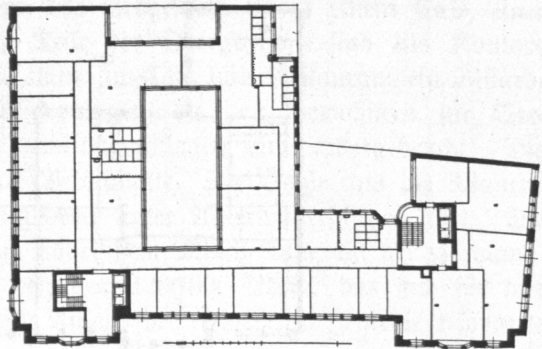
Neue Sparkasse, Grundriß des zweiten Stockes.
